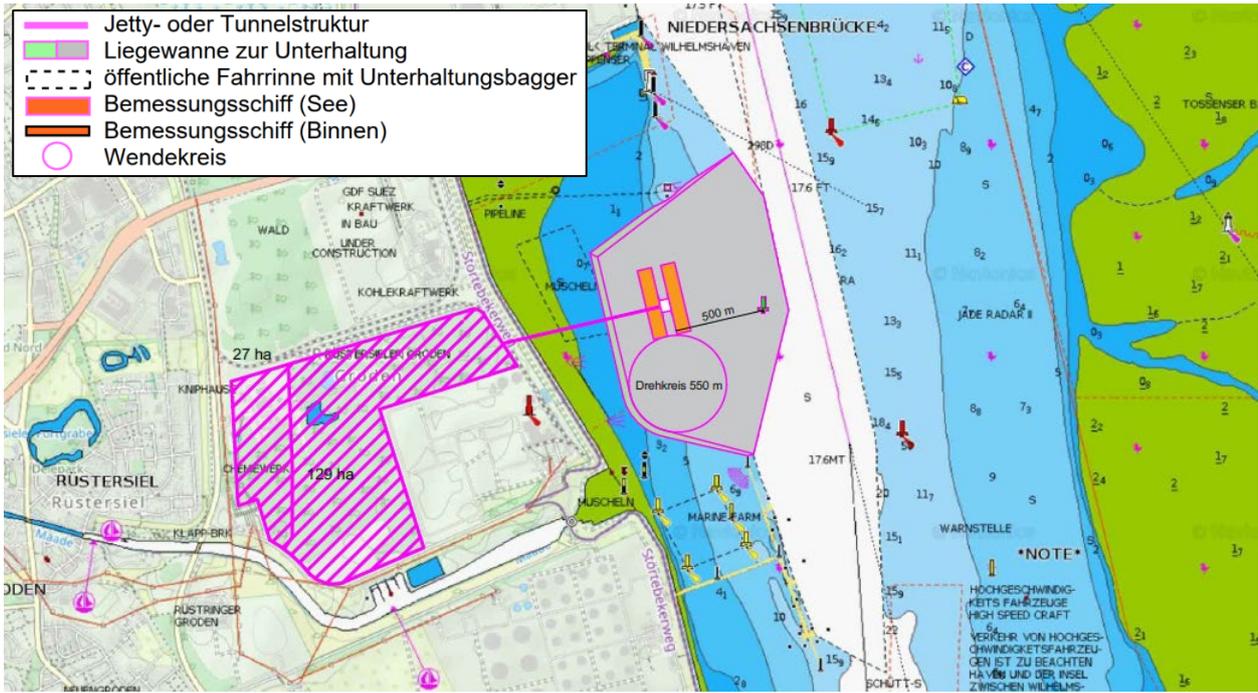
Lageplan Alternative 2: Wilhelmshaven (Rüstersieler Groden)¹⁷⁴
